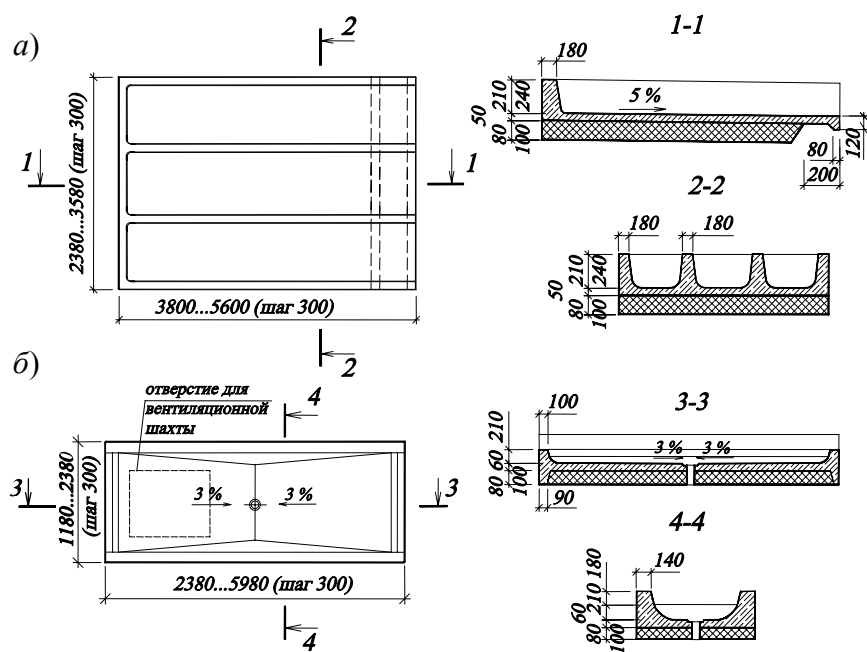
Сборные железобетонные двухслойные элементы покрытия крыш с теплым чердаком и безрулонной кровлей:
